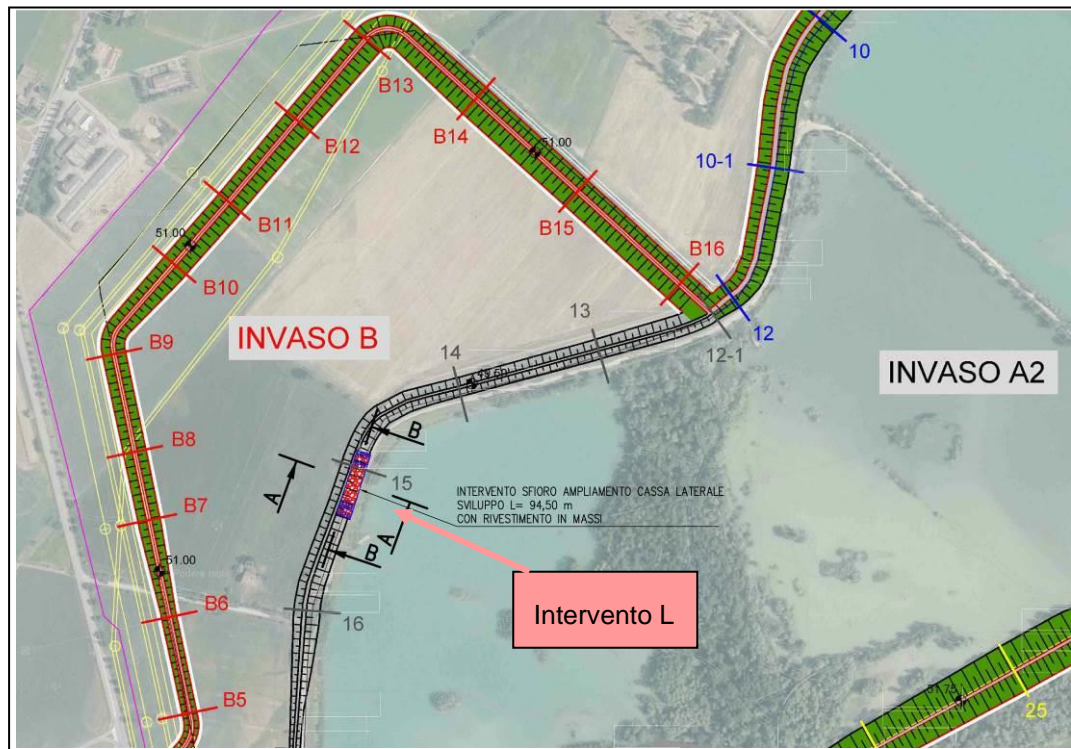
Intervento L: planimetria con posizionamento soglia di sfioro
